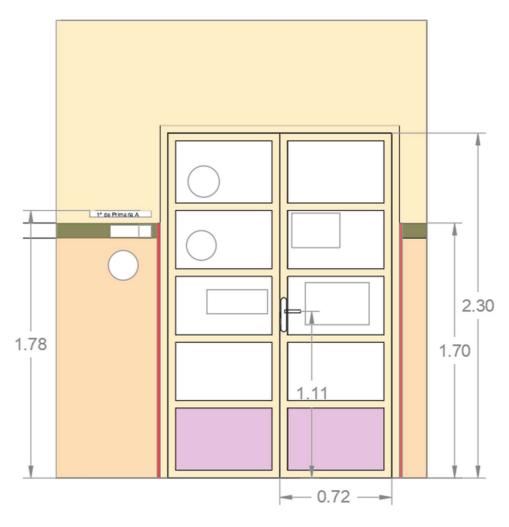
Representación en alzado del estado actual de la puerta de 1º de primaria A. Primera planta.
